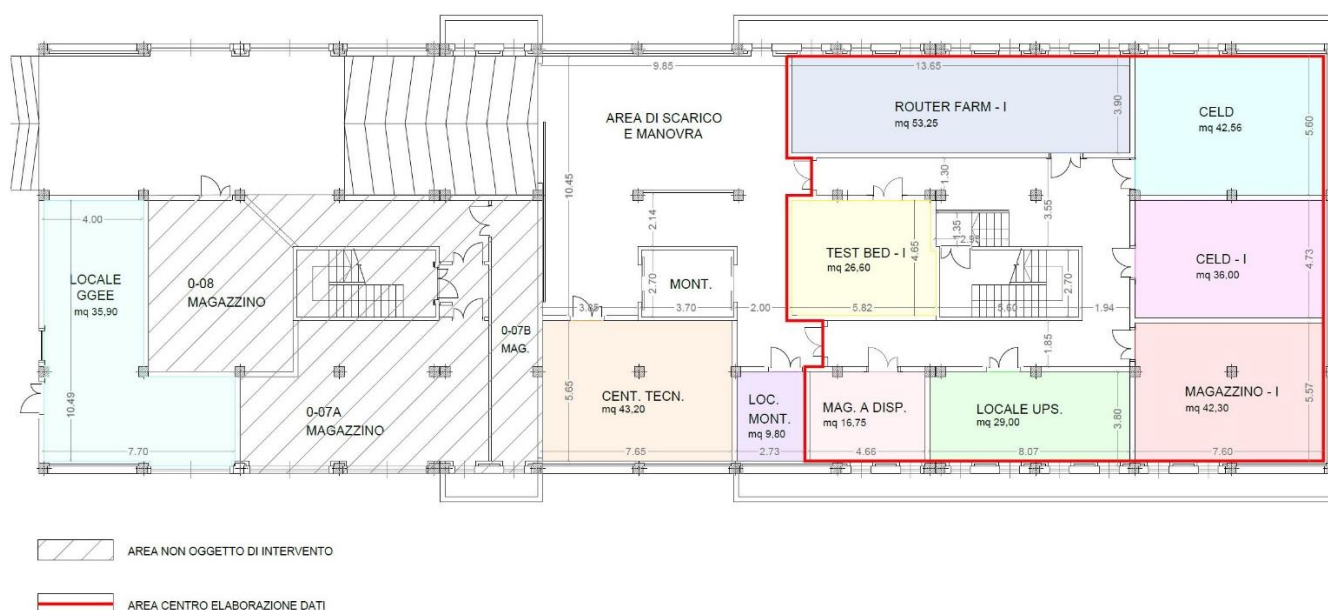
Opzione2- Layout dello stato di progetto nella soluzione con due accessi.
